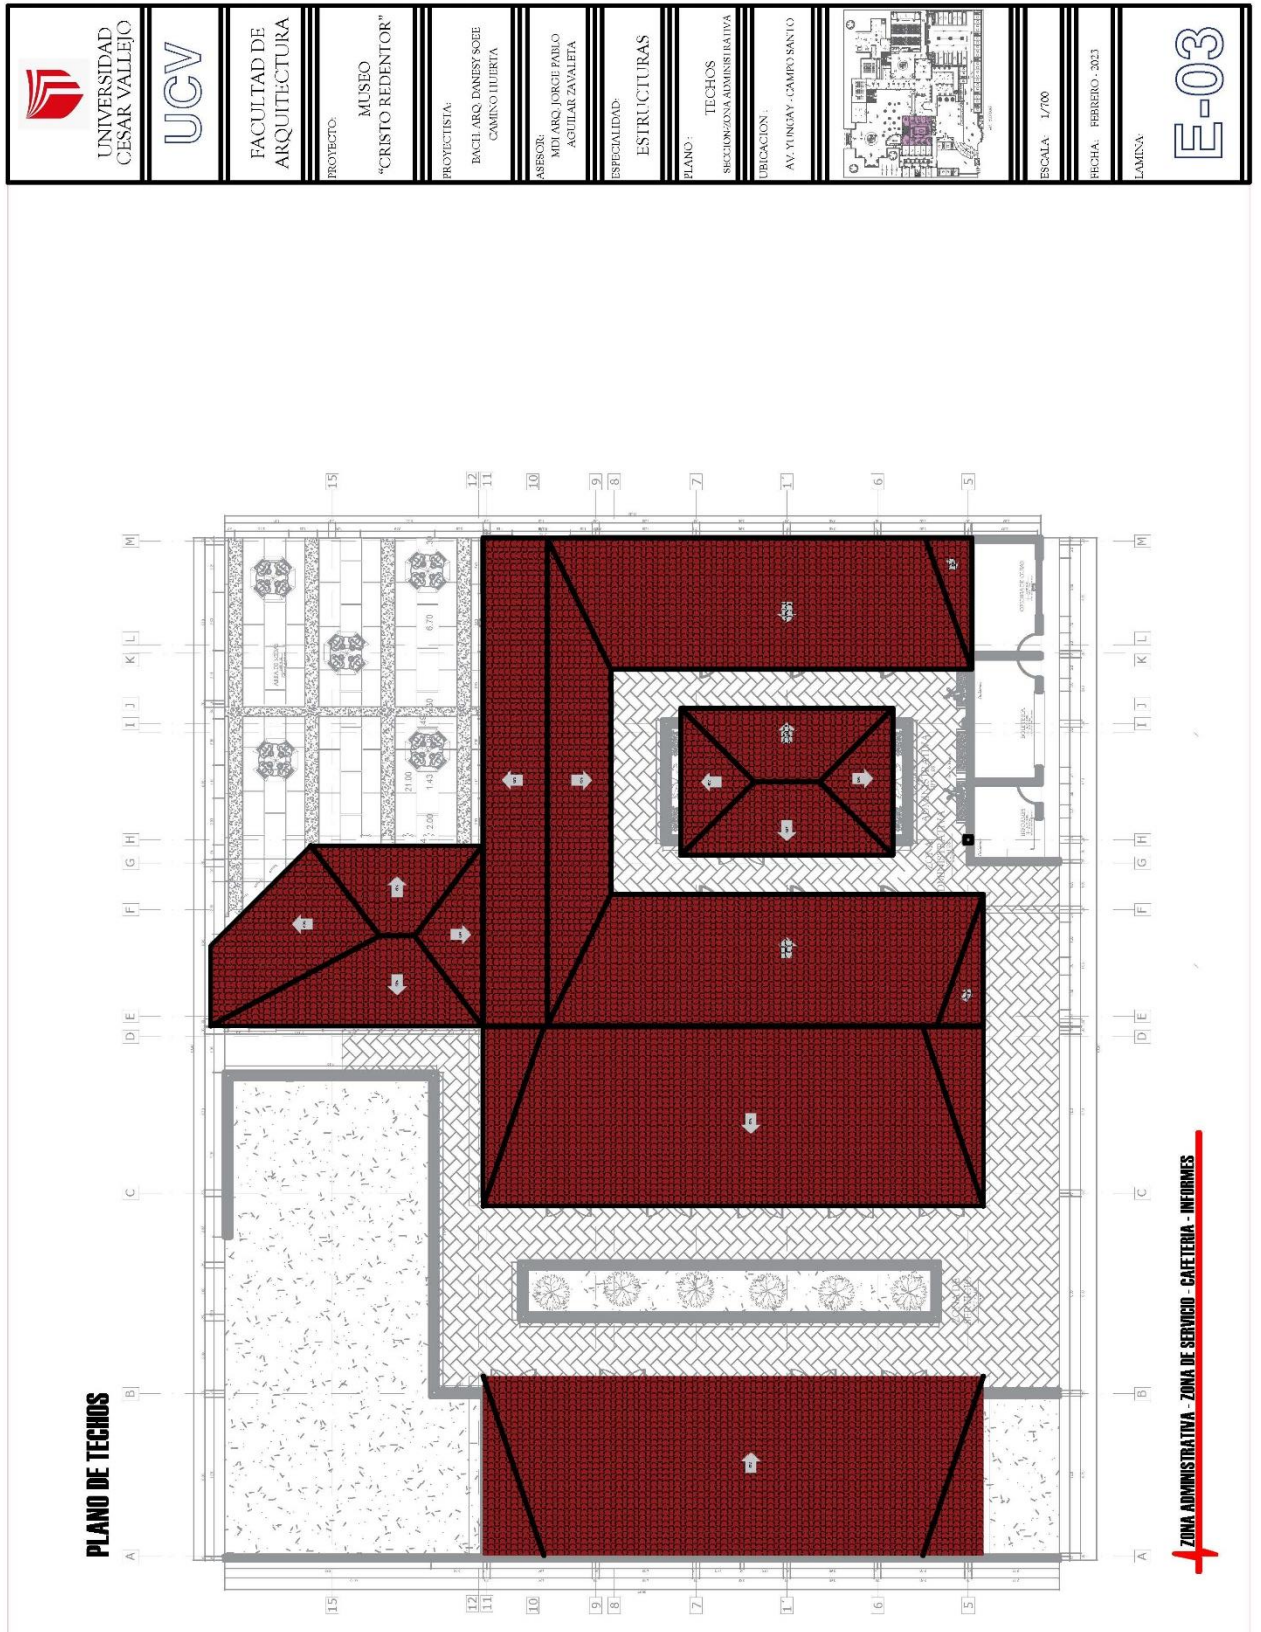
Plano de Estructuras – Techos del Museo “Cristo Redentor”
